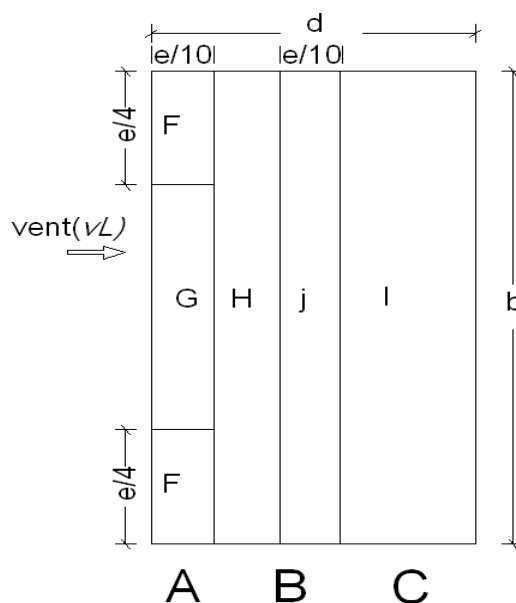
zones de coefficient(ce) sur toiture(longpan) vue en plan
